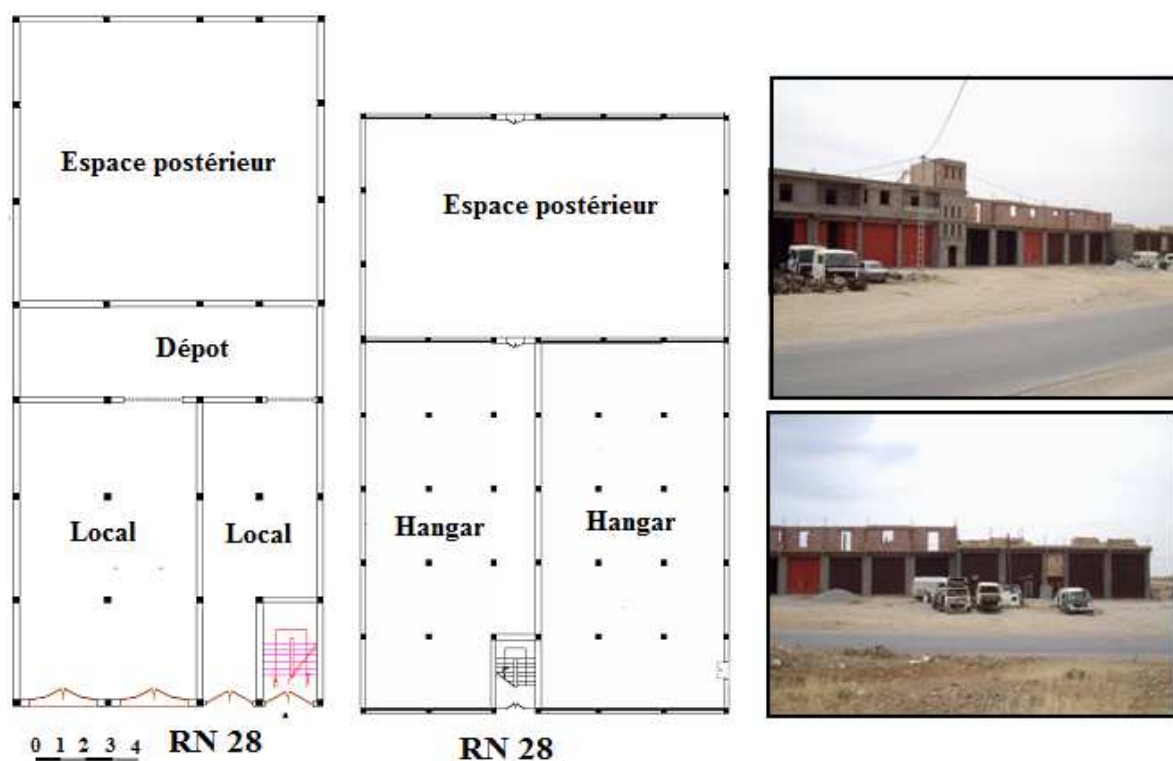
Exemple de dispositions spatiales préliminaires du type "Villas sur garage"
